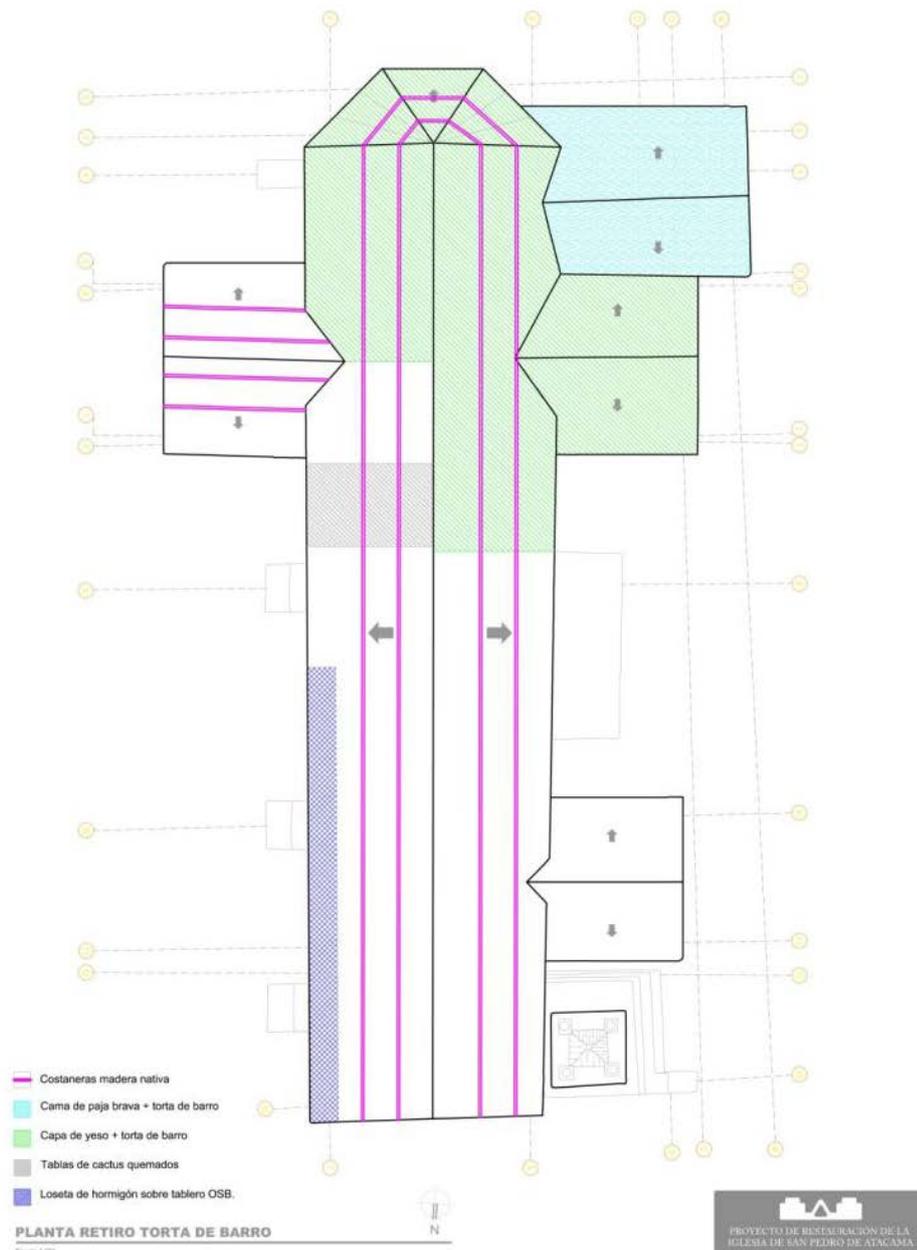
Planta de situación de la techumbre al retirar la torta de barro existente
